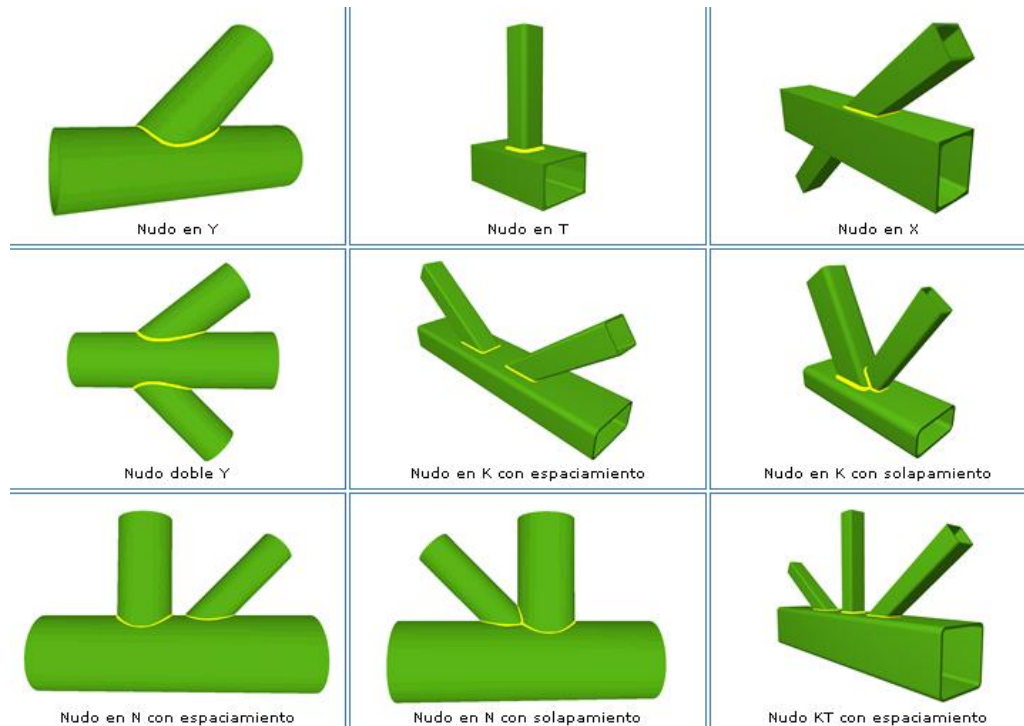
16: Tubos cuadrados soldados entre sí. (CYPECAD, 2014)
